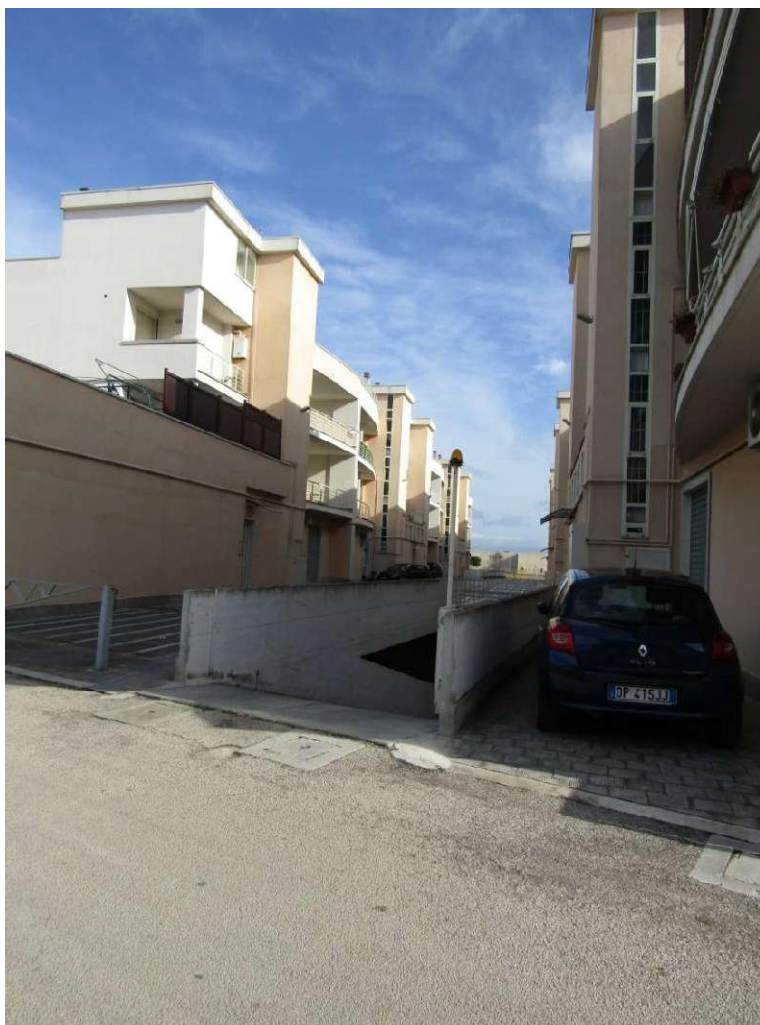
LOTTO 29 – BOX AUTO IN FOGGIA – FABBRICATO B – RAMPA DI ACCESSO AI BOX INTERRATI
